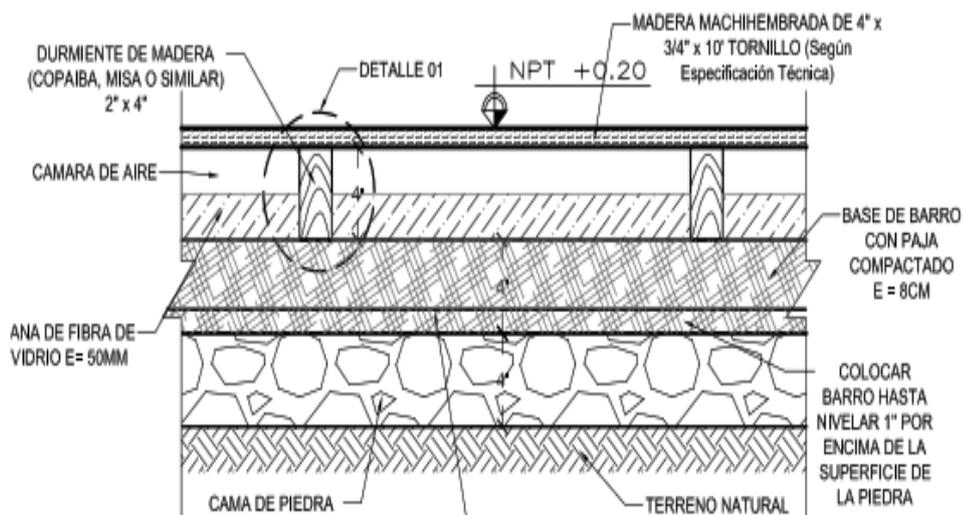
Detalles del piso de madera en los dormitorios de la vivienda rural.
